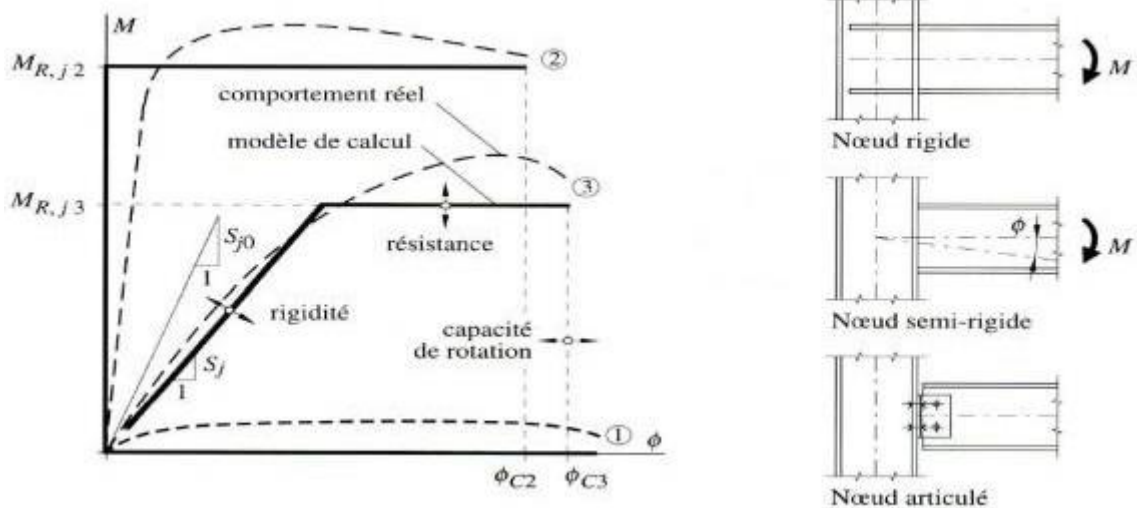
Comportement d'un assemblage poteau-poutre.
